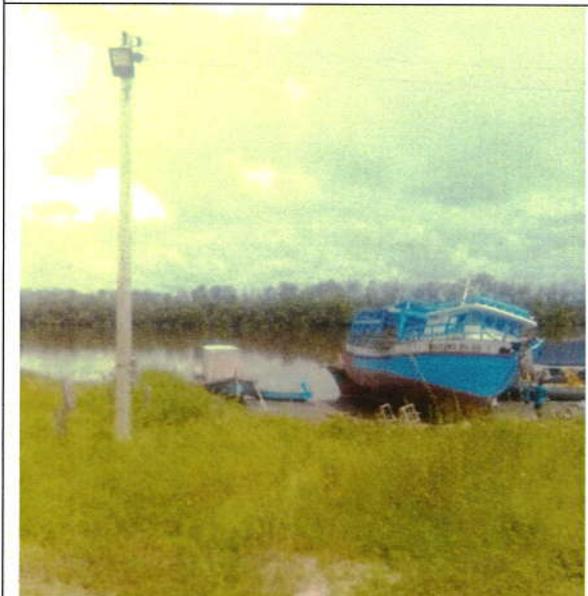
Trecho onde será implantado o sistema de drenagem da Vila Isaura - Jusante.
